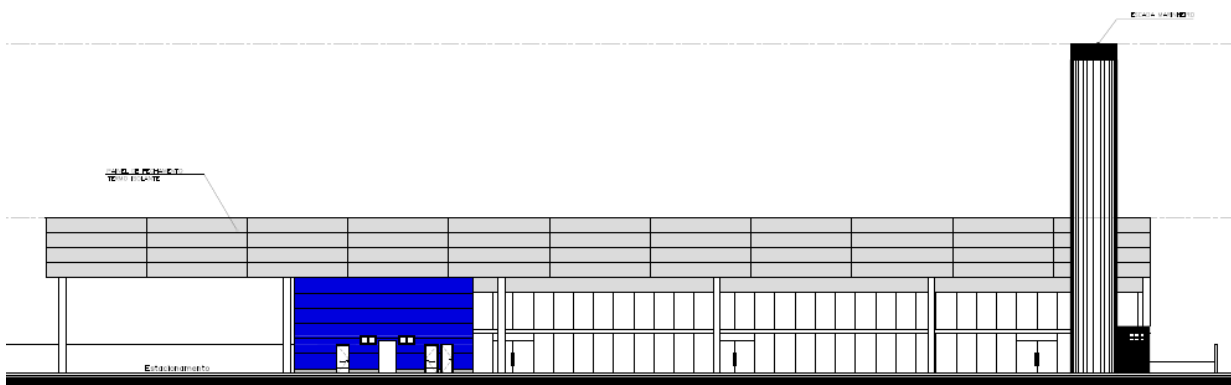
Vista da fachada frontal do futuro Costa Atacadão.
